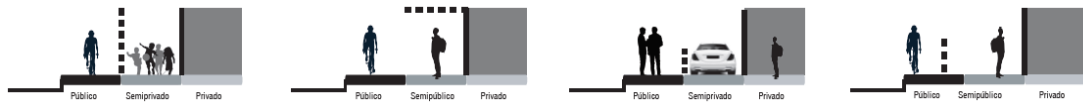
Fachadas Isla Trinitaria. Fuente J. Ortiz
